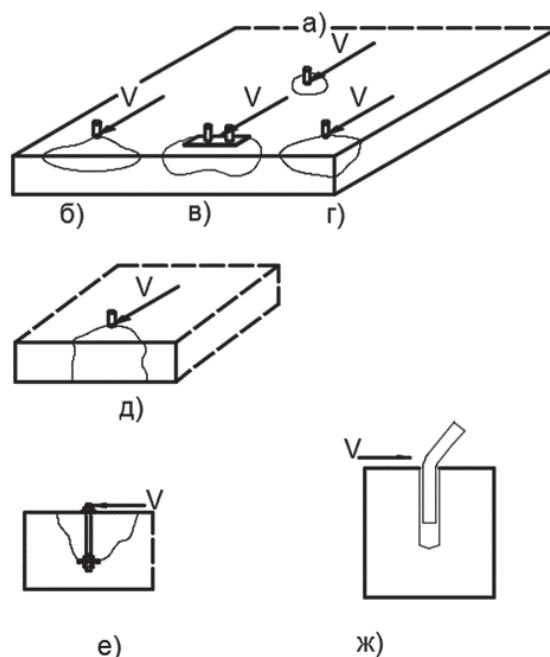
Механизмы разрушения анкерных болтов: а), б), в), г) срез по стали анкерного болта; д) отрыв грани основания; е) разрушение бетона за анкером; ж) вырыв анкерного болта из бетона
